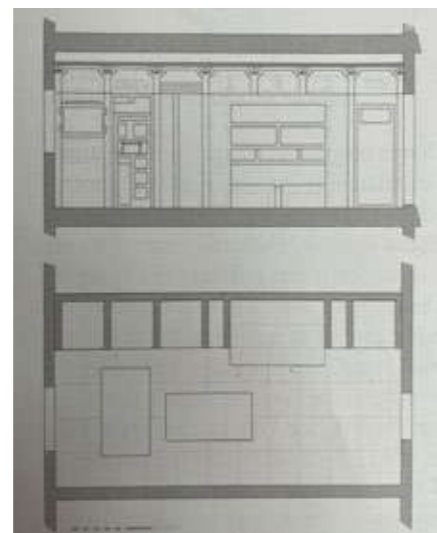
Reconstrucción alzado derecho y planta del apartamento de Korben Dallas, Utopías: Arquitectura de ciencia ficción.
